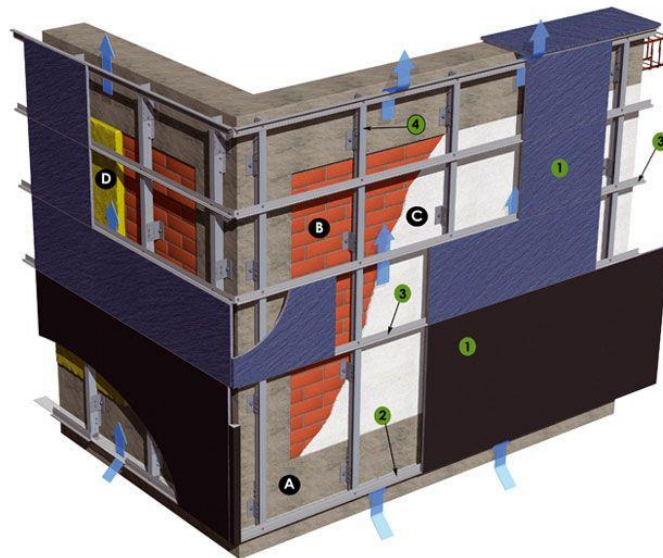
Detalle constructivo de la fachada Ulma (Ulma, 2014)
